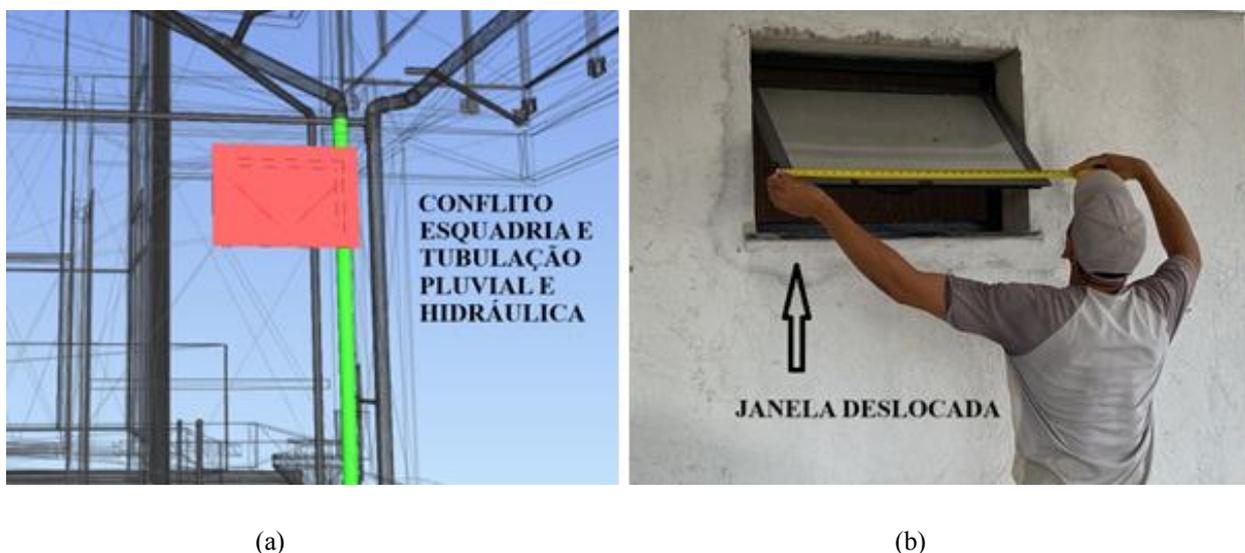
Conflito de tubulação hidráulica atravessando vão janela banheiro suíte *master*: (a) detecção no Navisworks (b) solução em obra
